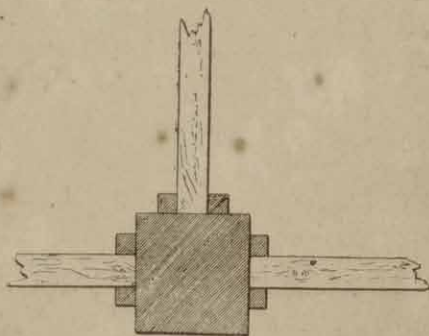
Détail d'un assemblage des caissons sur un plateau.
